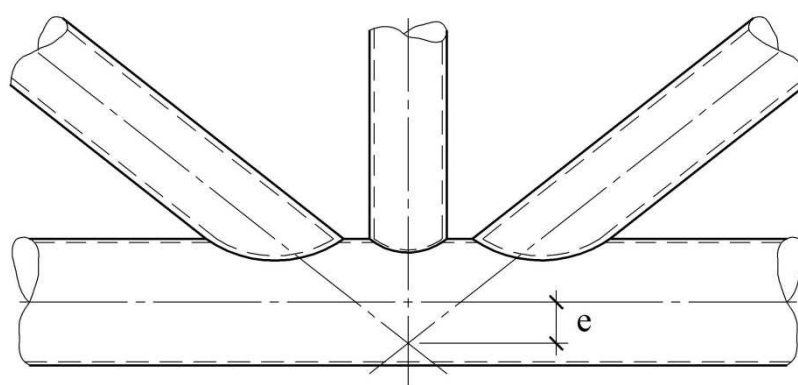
Вариант промежуточного узла нижнего пояса стропильной фермы из круглых труб с расцентровкой пересечения осей раскосов с нижним поясом
